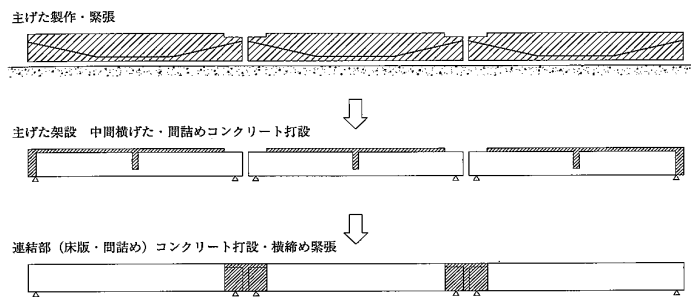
RC 連結方式 T 桁橋の施工手順
